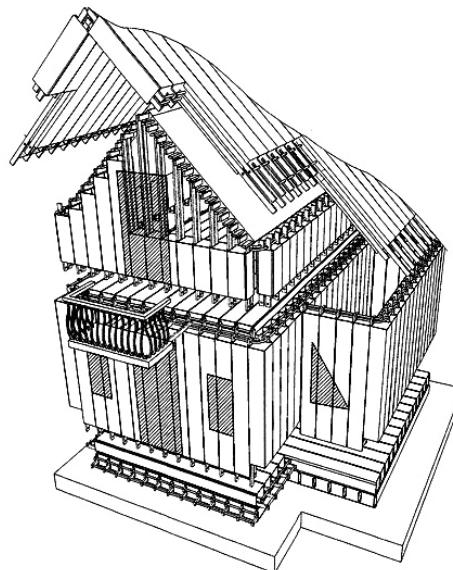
Каркас здания, собранный из текстильных несъёмных опалубок здания, не заполненных бетоном
